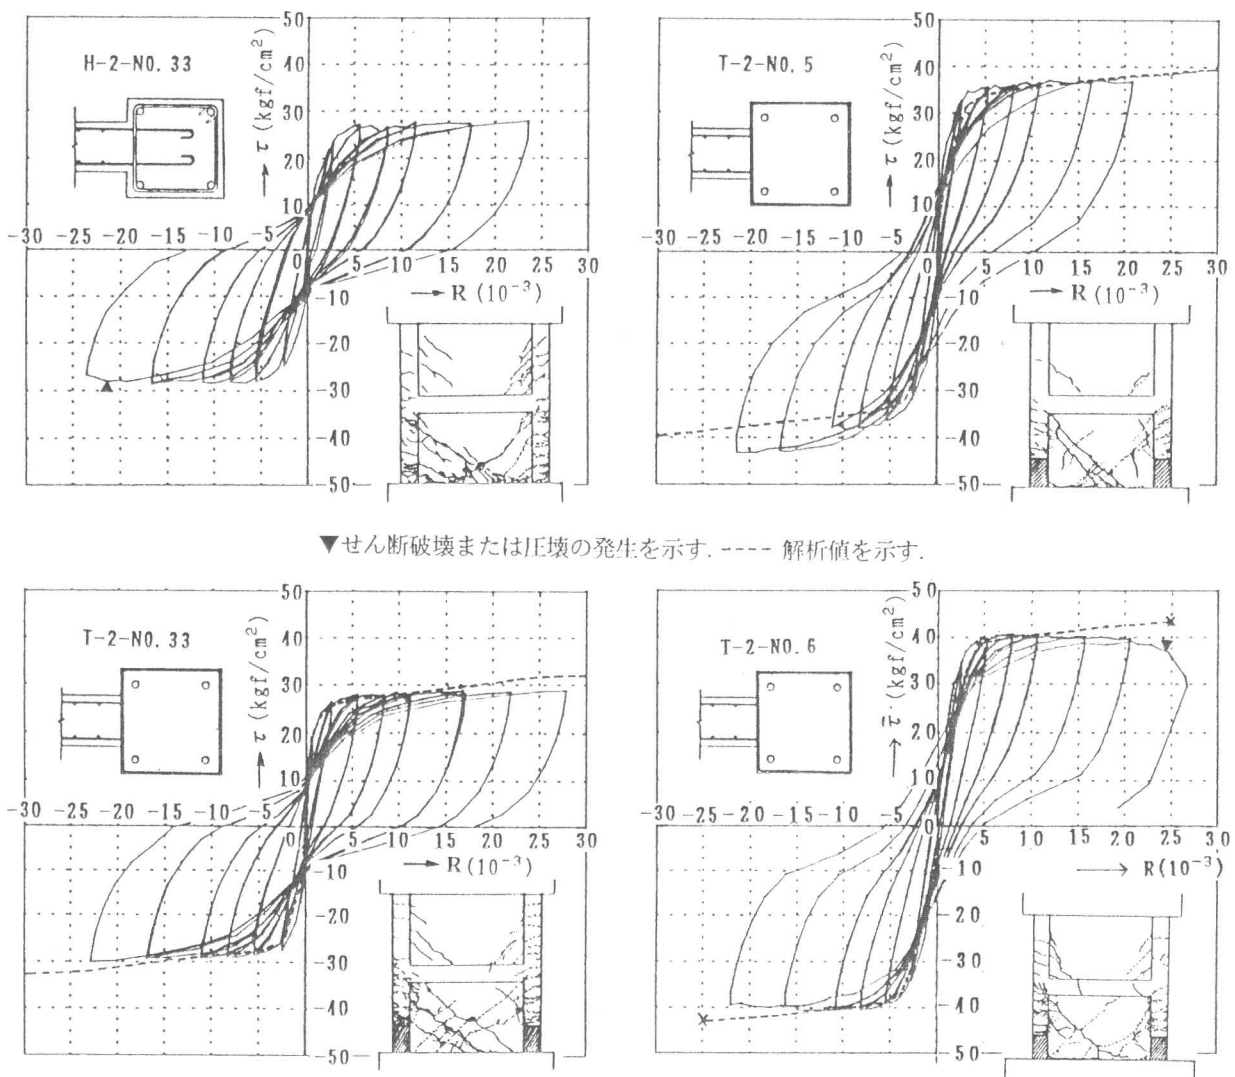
a せん断スパン比2の各試験体の履歴性状および終局時ひび割れ状況
